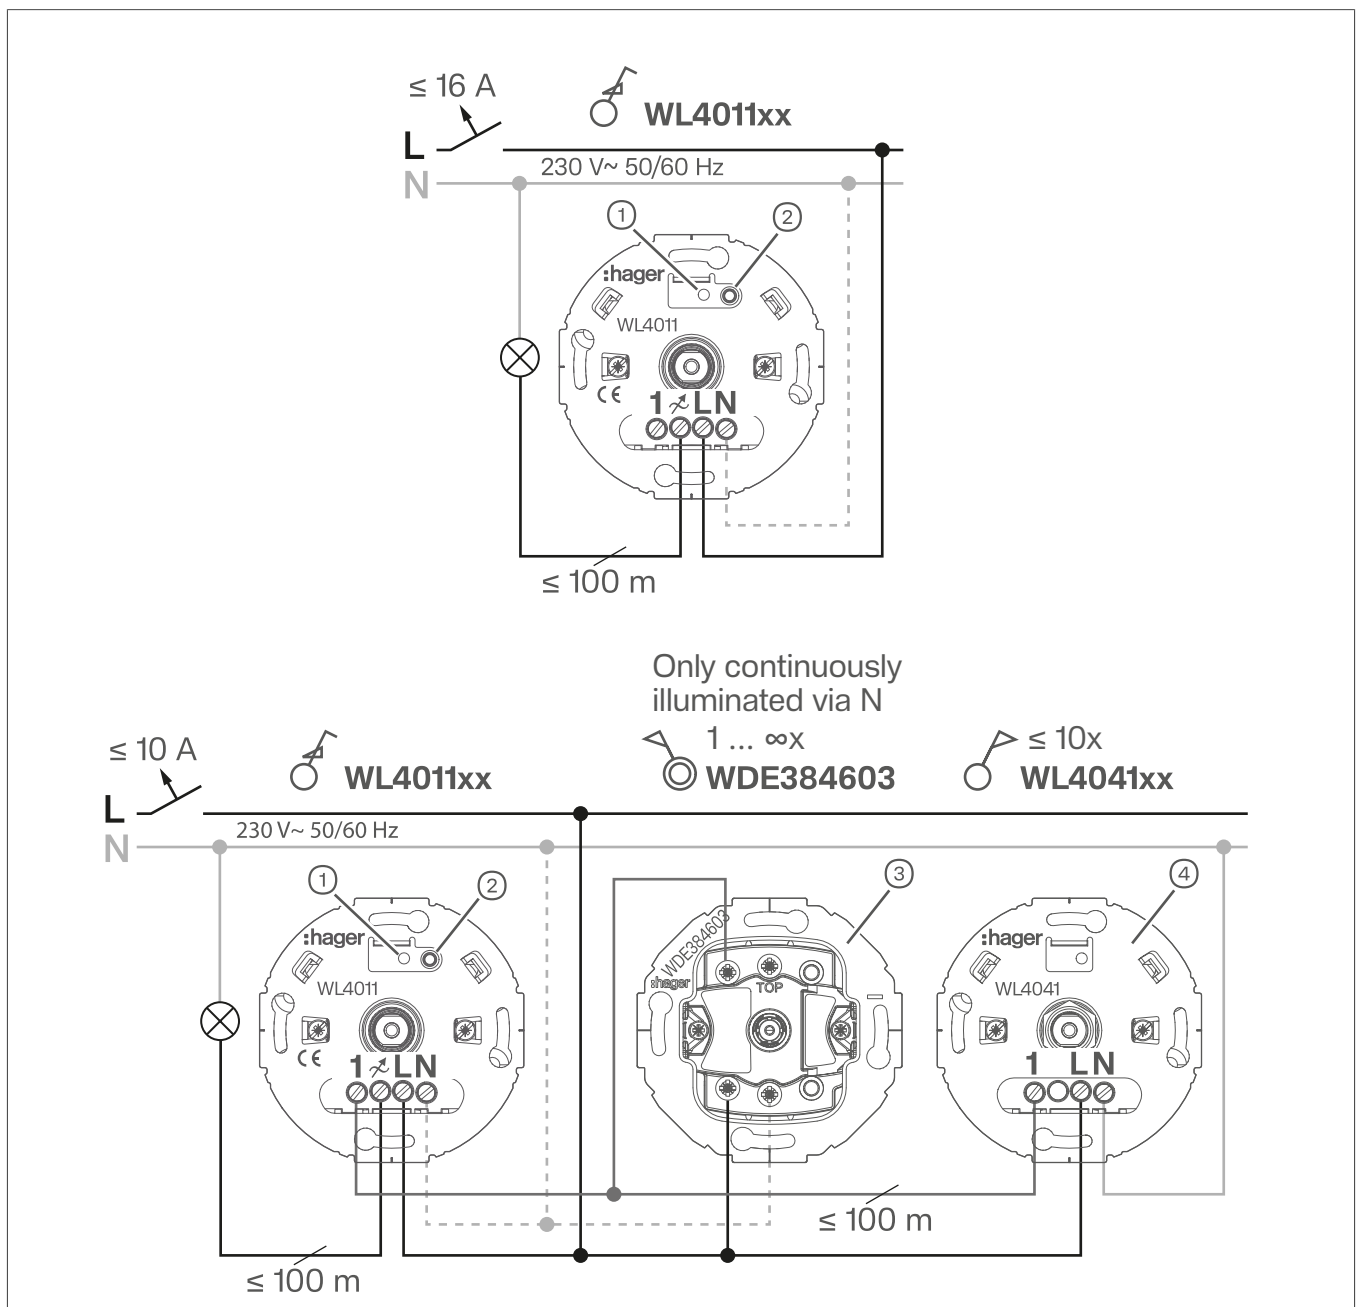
Anschlussplan Einzeln und mit Nebenstellen
